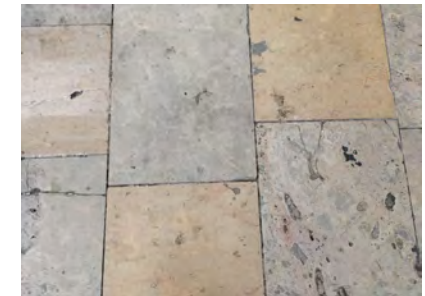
Pavimento de zonas de calle Navellos y Plaza de la Virgen. Buenas características aunque resbaladizo en mojado
